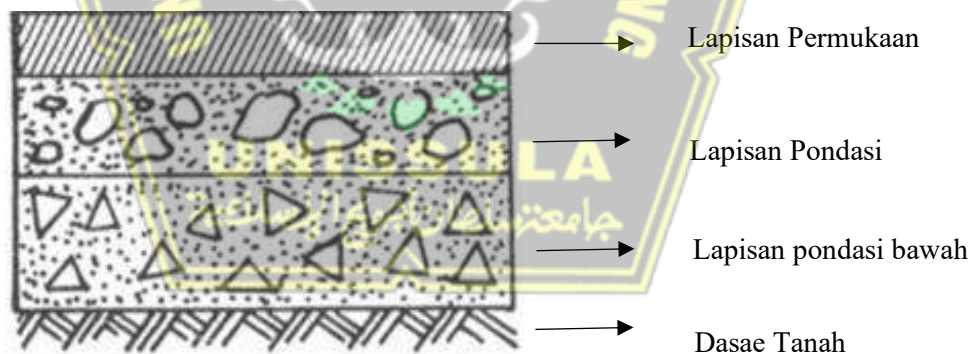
1 Lapisan Konstruksi Perkerasan Kaku (*Rigit Pavement*)
